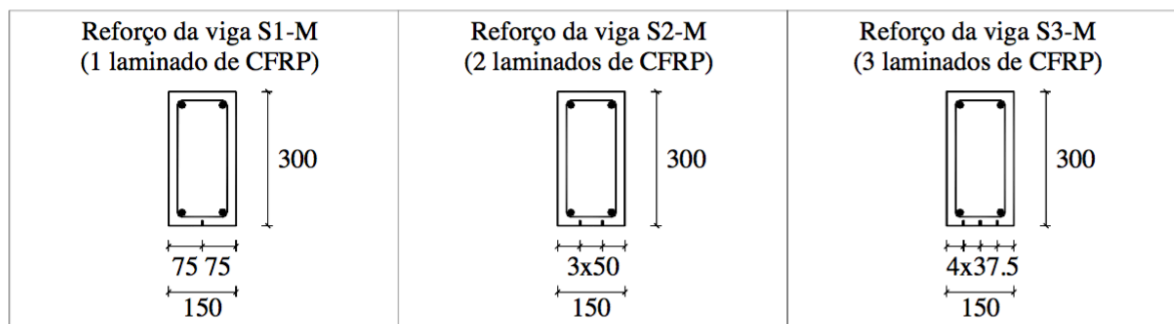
Seção transversal das vigas reforçadas (Fonte: Dias *et al*, 2012)
